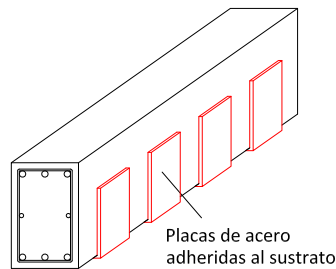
Refuerzo con placas de acero distribuidas en forma de estribos.
